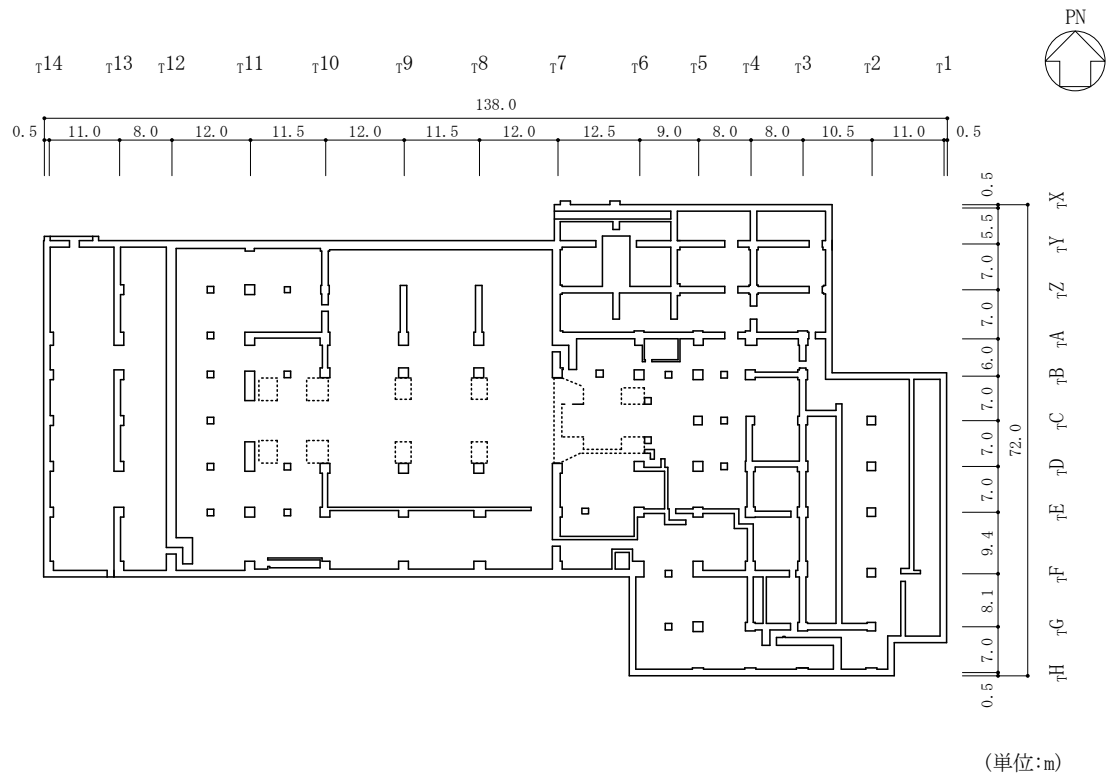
(1) タービン建物の概略平面図 (EL 2.0m)
